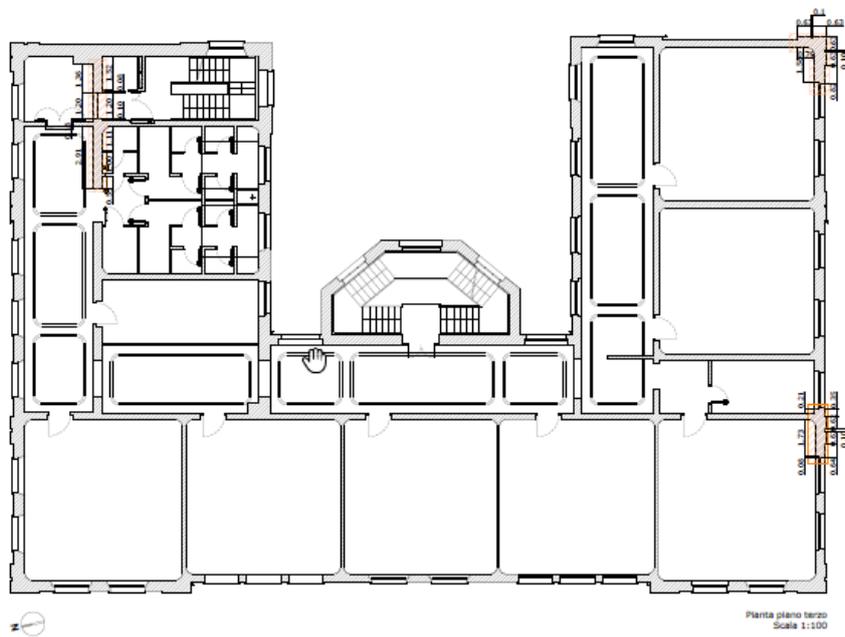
Pianta piano Terzo con indicazione delle zone di intervento
